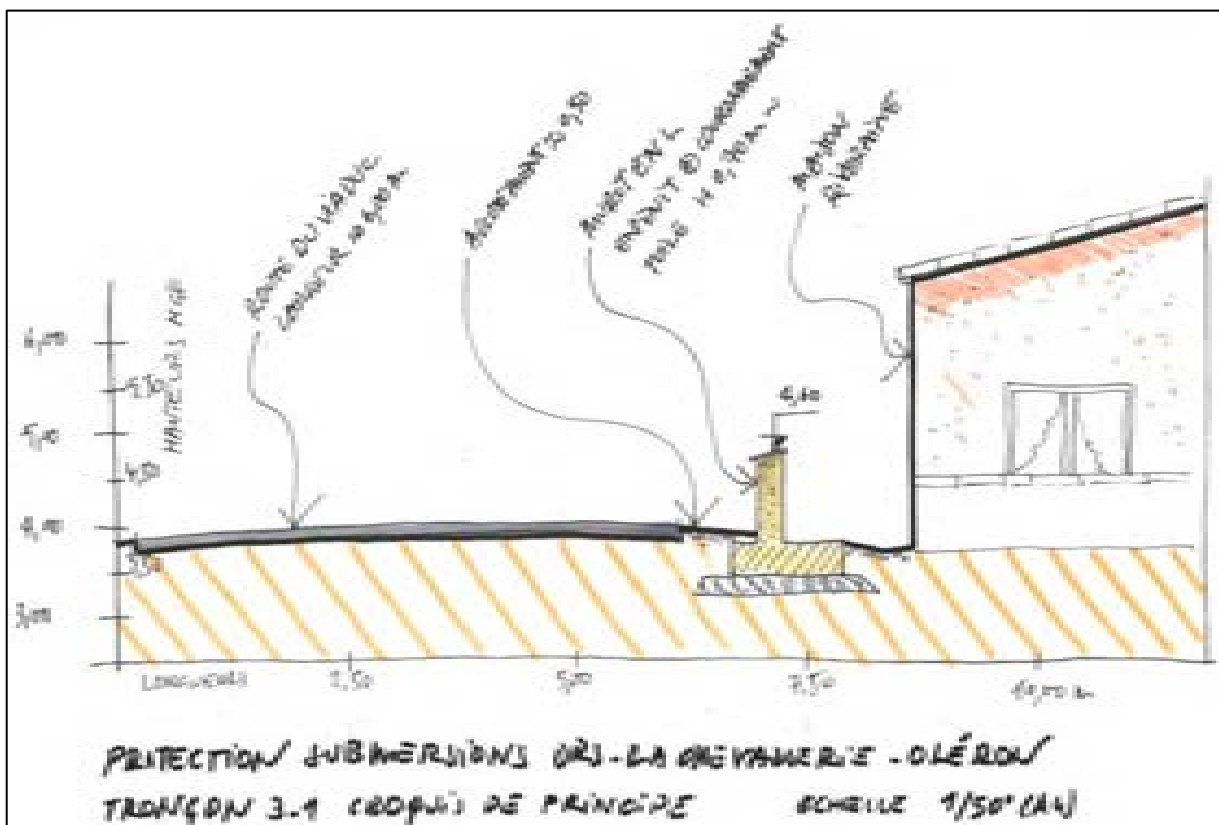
Croquis de principe du muret sur le tronçon TR3-1 bis
